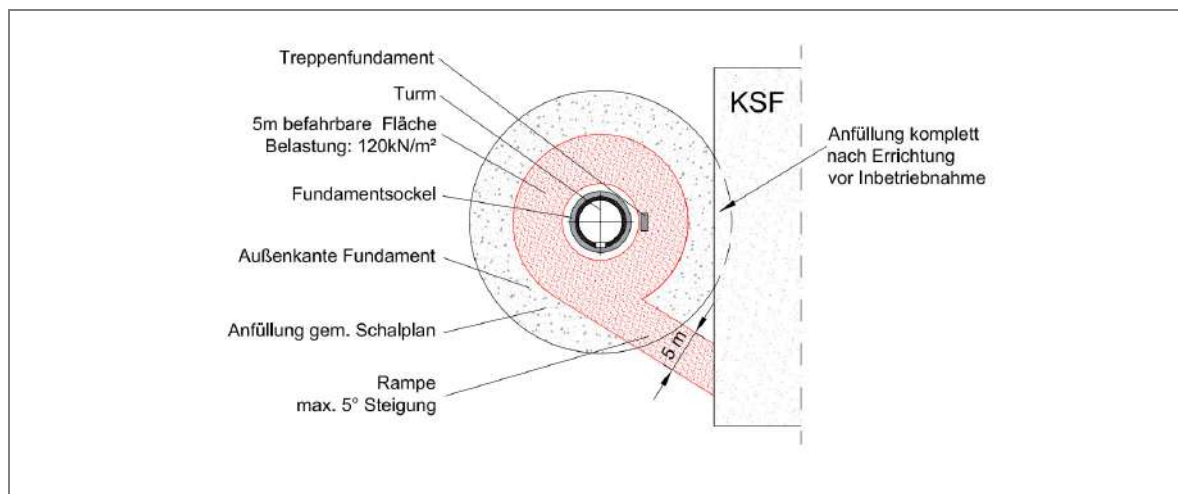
Rampe zwischen KSF und Fundament bei Stahltürmen mit Außenflansch
